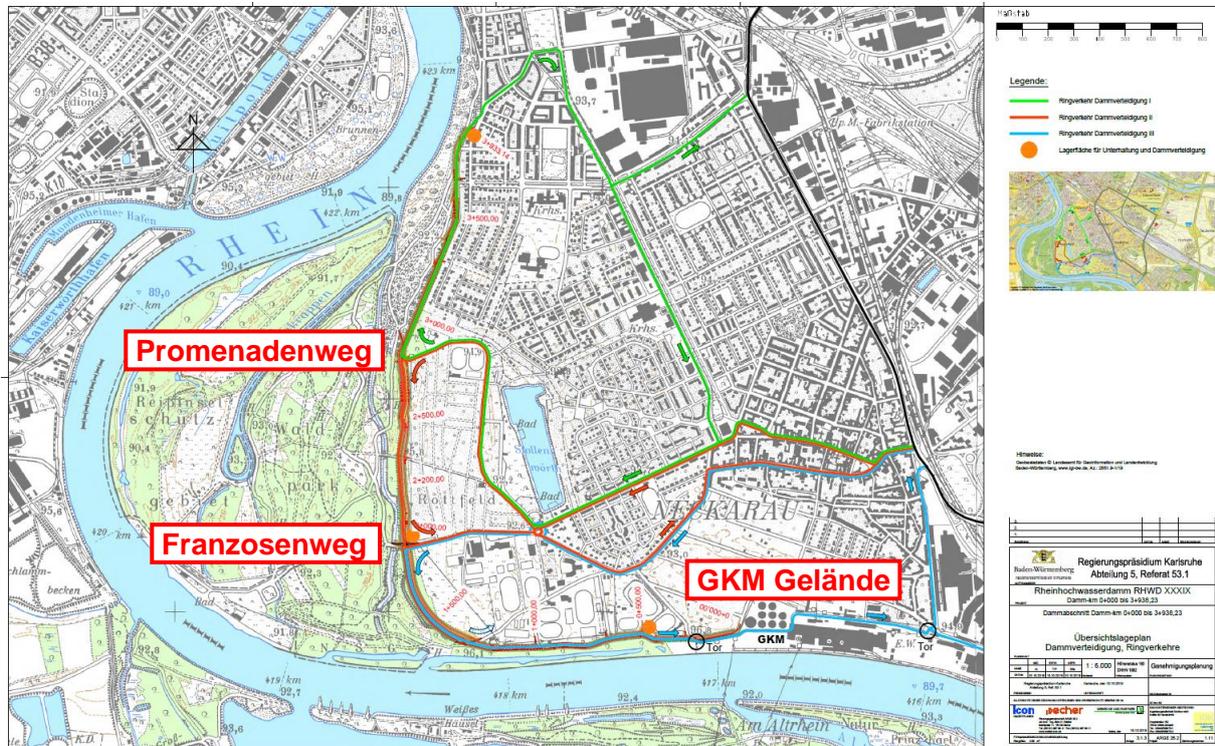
Übersichtslageplan Dammverteidigung / Ringverkehre, Plan Nr. 1.11
